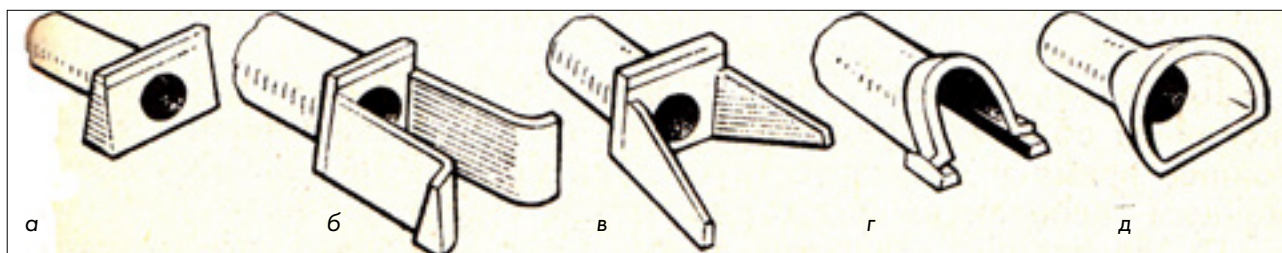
Виды оголовков: а – портального типа.; б – коридорного типа; в – раструбного типа; г – воротникового типа.; д – обтекаемого типа;
